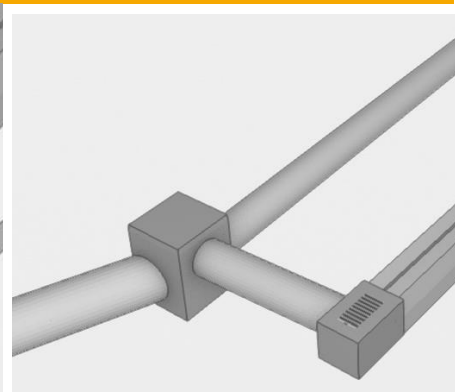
Branchement de réseau d'assainissement (Caniveau à fente vers canalisation)
